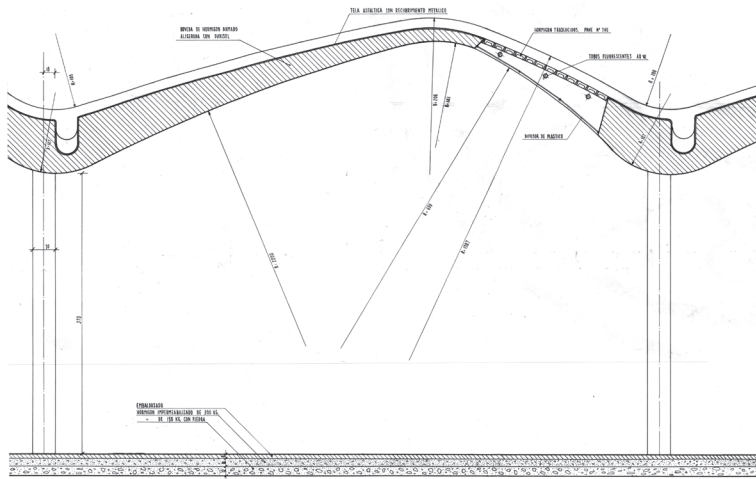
Detalle Constructivo de las bóvedas de la nave de talleres. Plano 8. Proyecto del Instituto Laboral de Tánger. 1955. Archivo Histórico COAC C2577/67.
